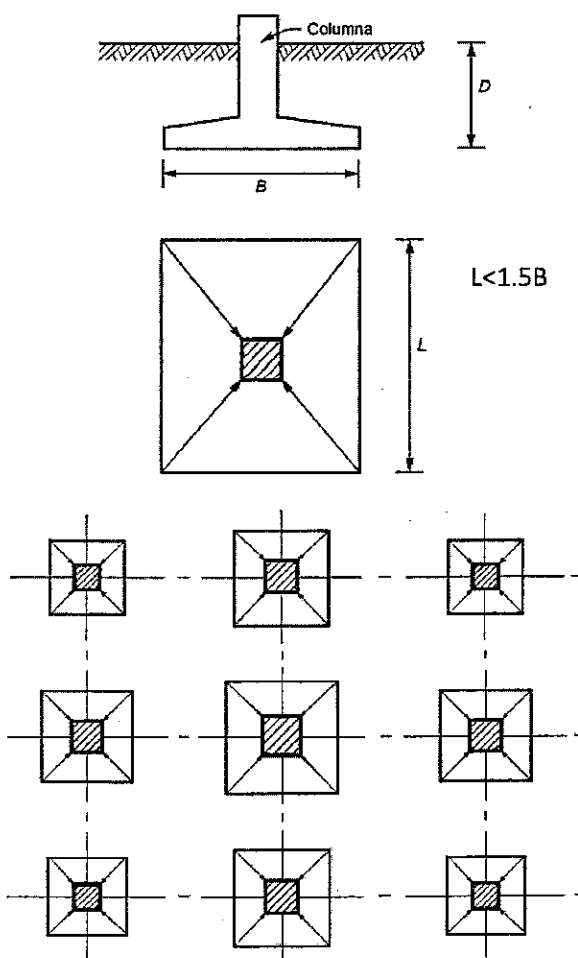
Cimentación aislada (ZEEVAERT, 1973)
